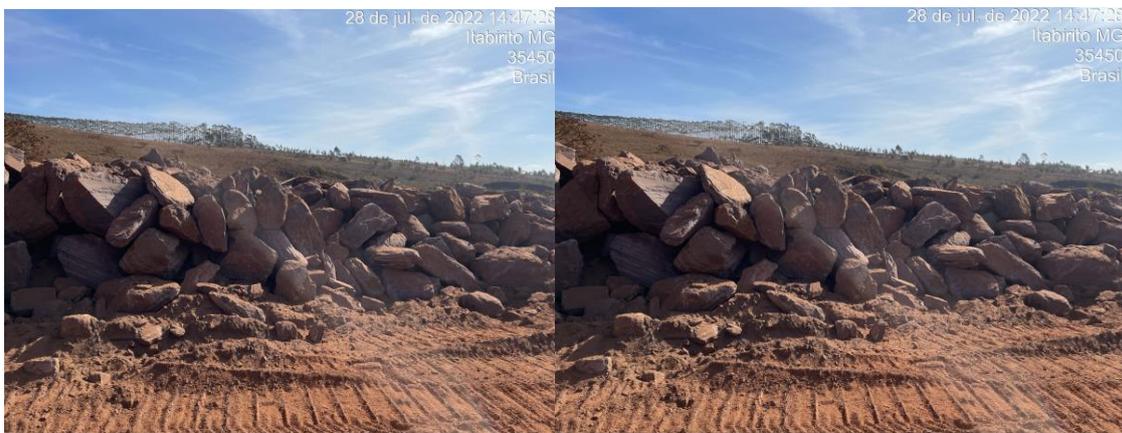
Enrocamento sendo construído conforme especificação em projeto.
